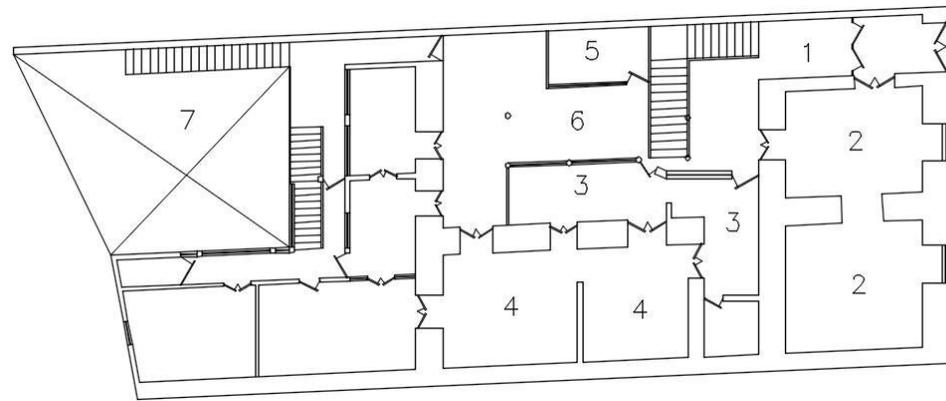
Planta de la Casa de Artesanías Sumaglia.
